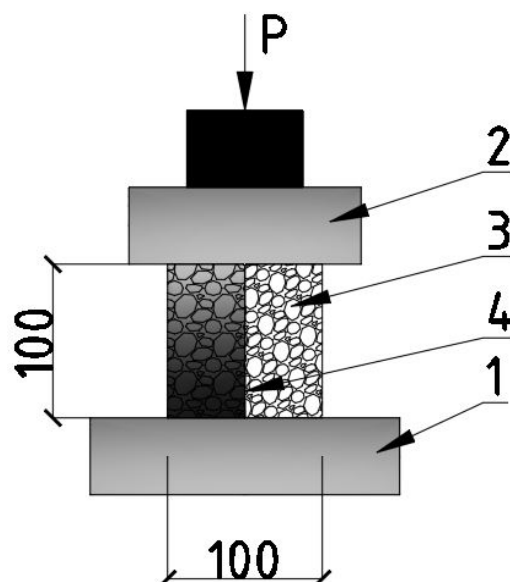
Схема проведения испытаний бетонного кубика на сжатие в зоне технологического шва: 1 – опорная площадка прессы; 2 – рабочий шток прессы; 3 – испытываемый образец; 4 – плоскость рабочего шва
